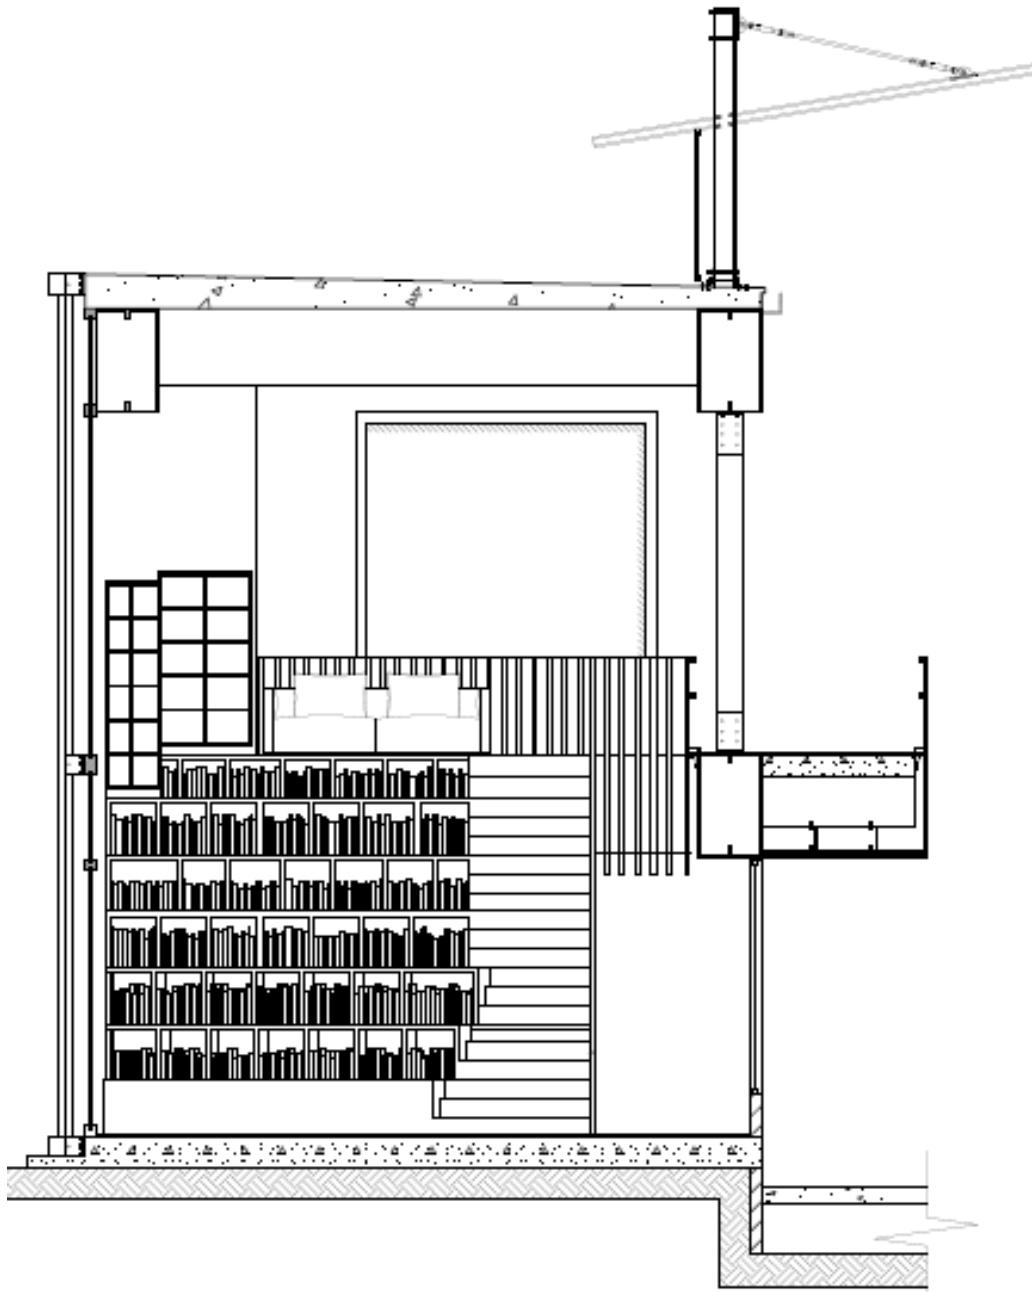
Vista 1 escalera biblioteca. Fuente: Elaboración propia
